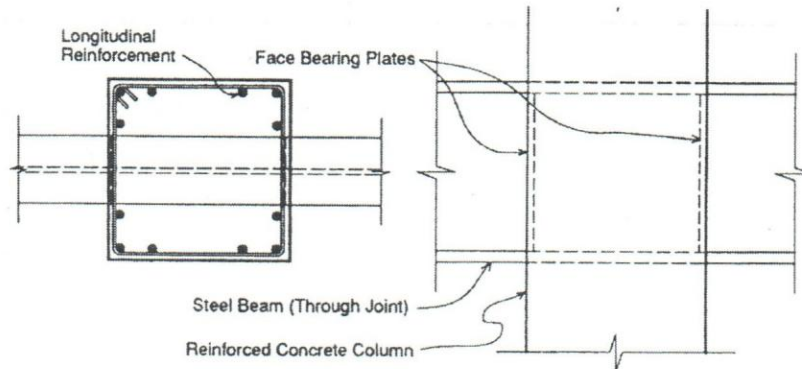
Conexión de empotramiento entre viga de acero y columna de concreto reforzado²²
